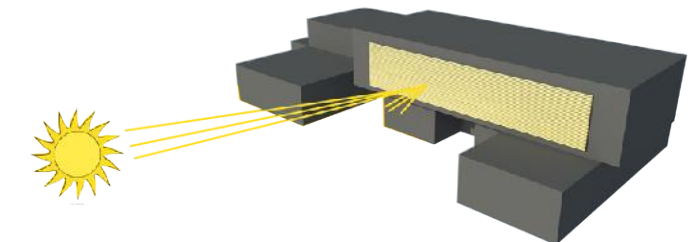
Incorporación de parasol a la fachada sur poniente. 2017. Fuente: Autor.
